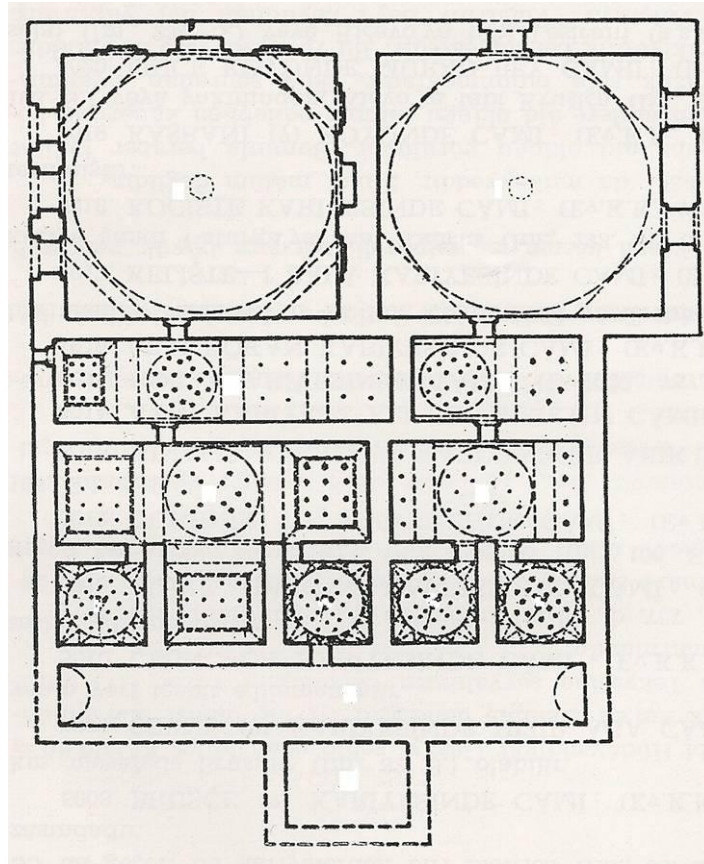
Çifte Hamam (Kastamonu) plan şeması
